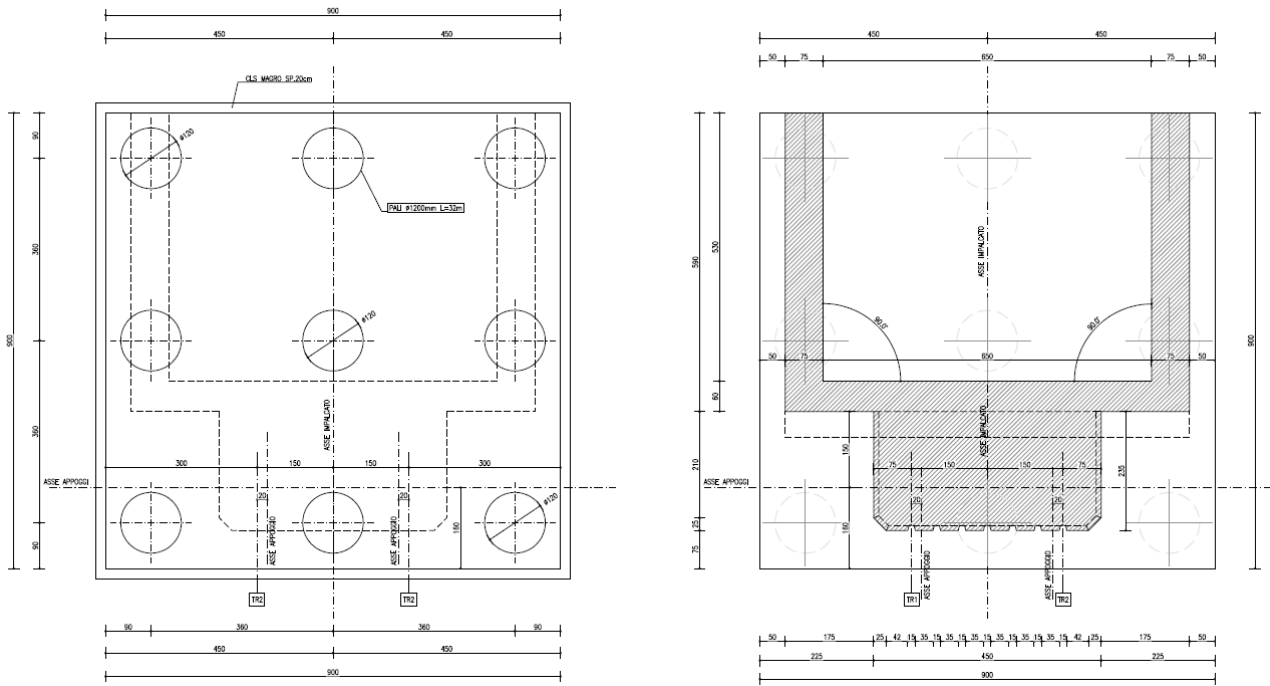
Spalla 1 – carpenteria fondazioni
